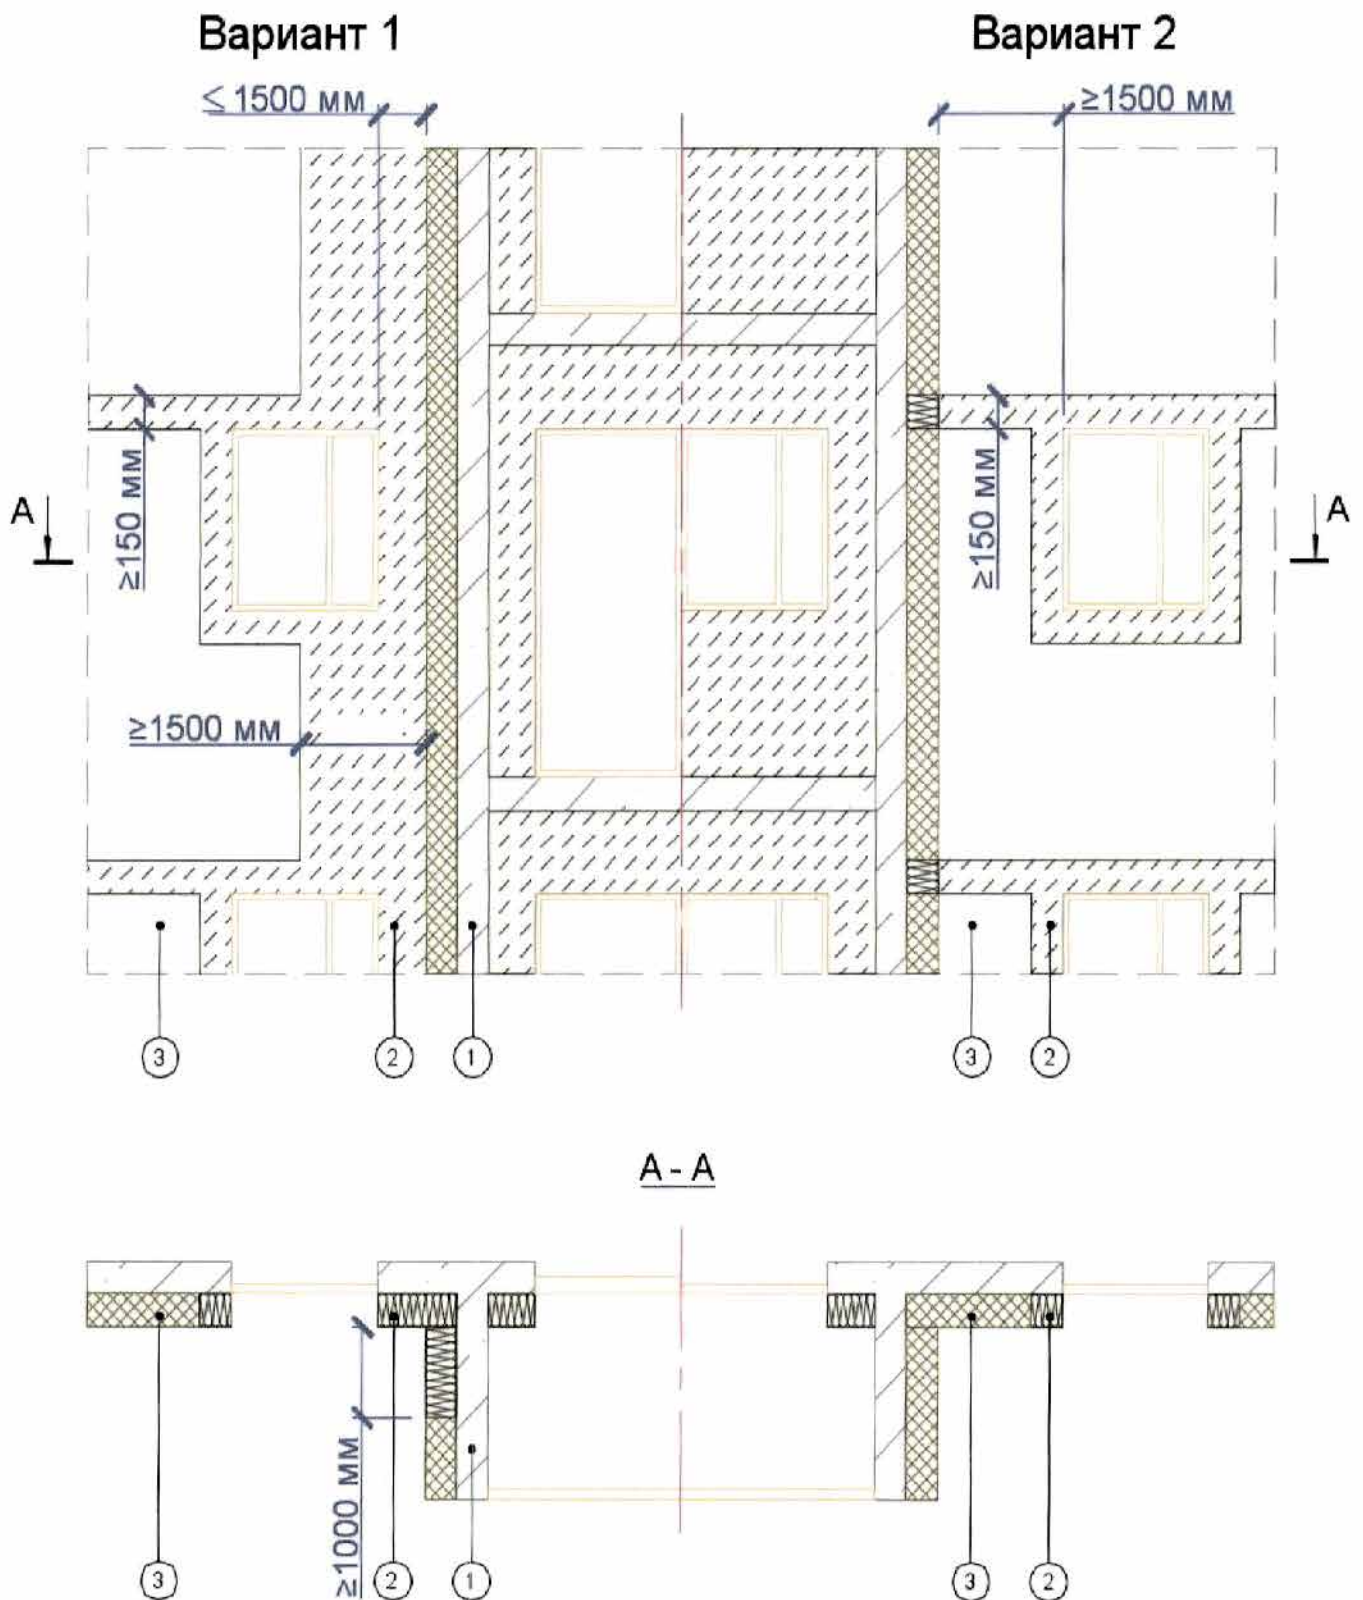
Участки наружных стен по периметру эвакуационных выходов из здания
